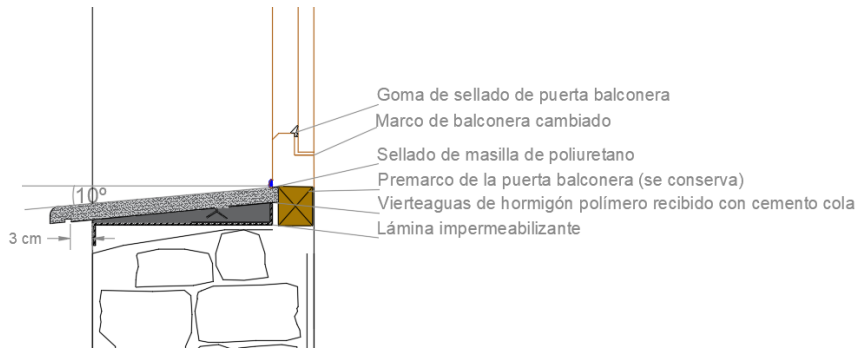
Detalle vierteaguas y puerta balconera. Fuente: CAD propio
